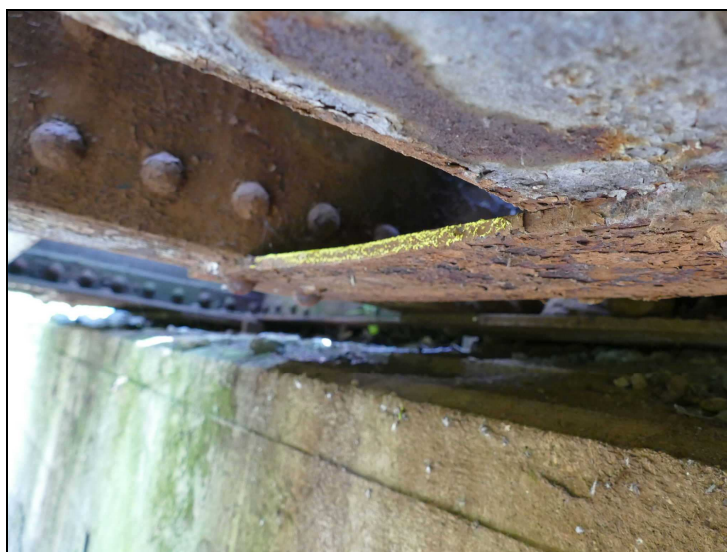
Konstrukce K 01 – příčné ztužení vlevo, mírná deformace
